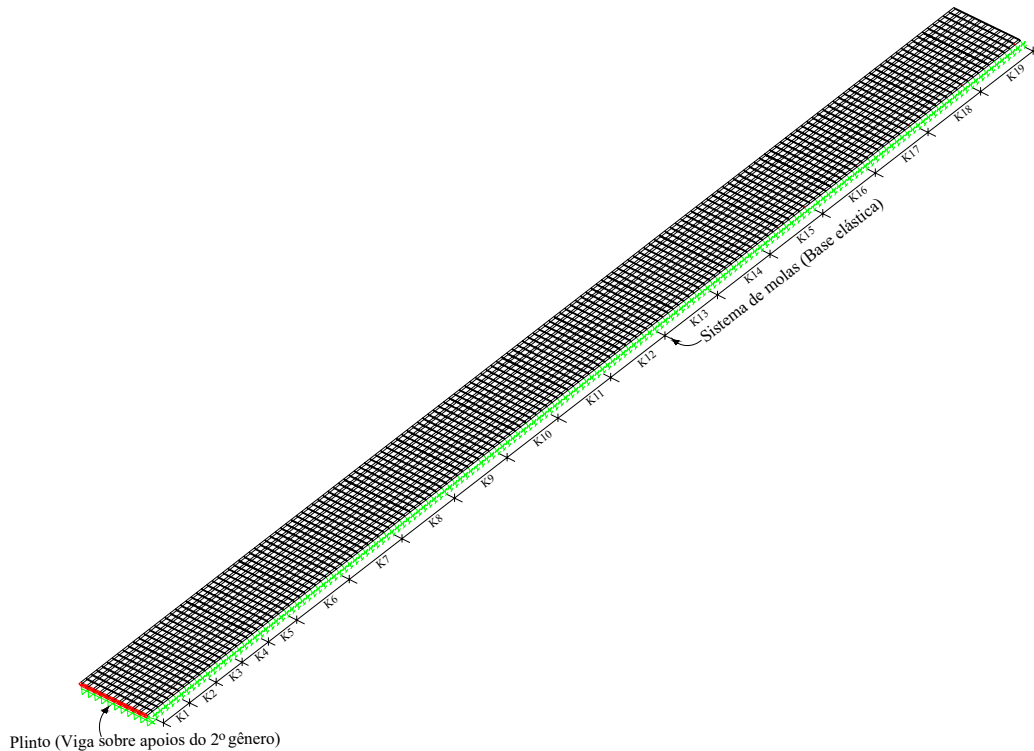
Modelo de estrutural da laje sobre apoio elástico.
